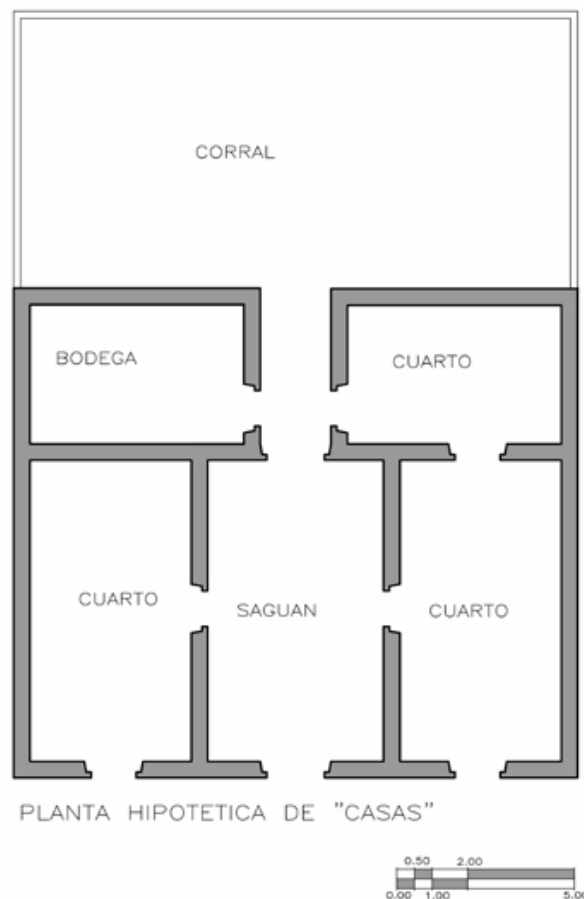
Planta Hipotética de “casas”, por X. Guevara, México, 2014
